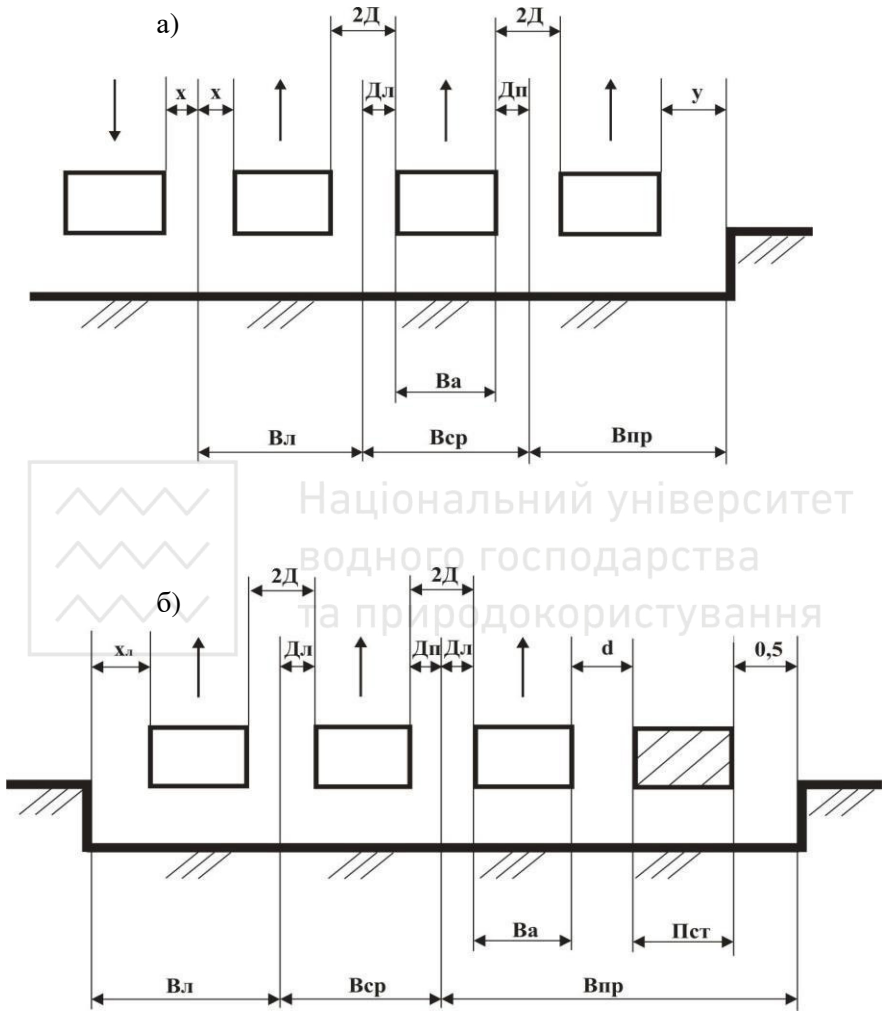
Схеми для визначення ширини смуг руху:
